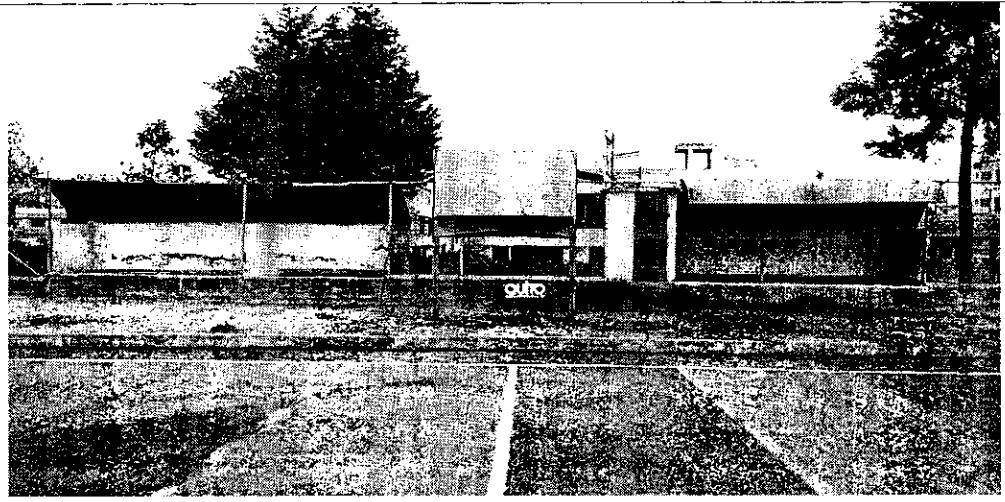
Cubierta, graderío, cabinas y reflectores.
